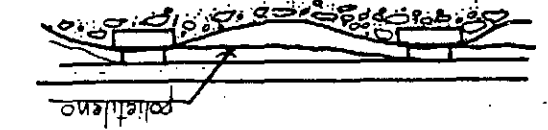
IMPERMEABILIZACION EN CEMENTA
